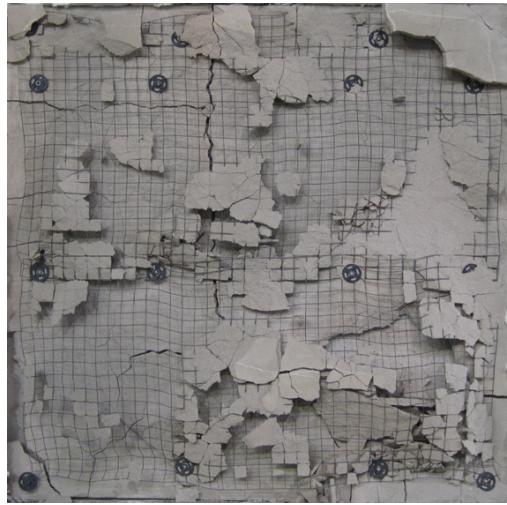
耐火試験後の状況 (No. 9) [V1]
